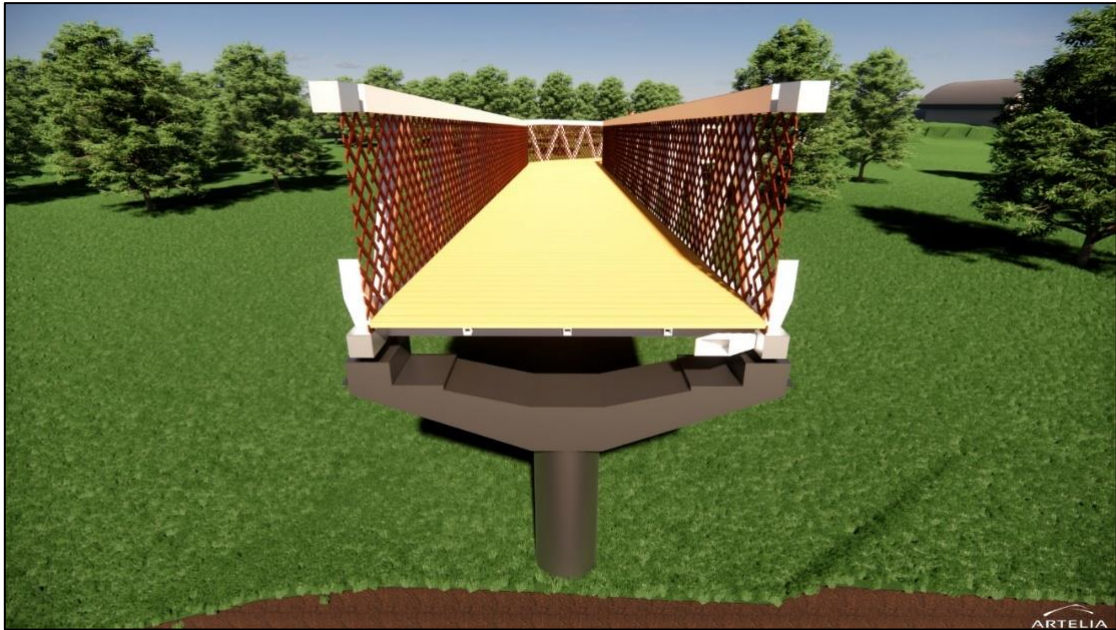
Vue 3D des futures piles P1, P7 et P8 de la passerelle
